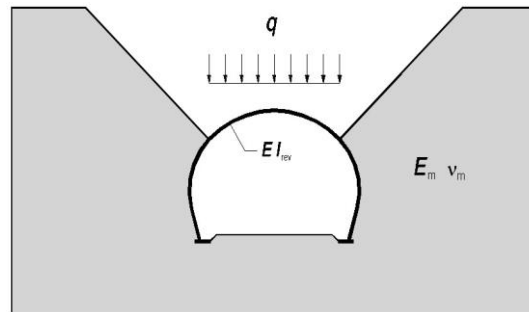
Análisis estructural por cargas de aflojamiento, (Consultec).
